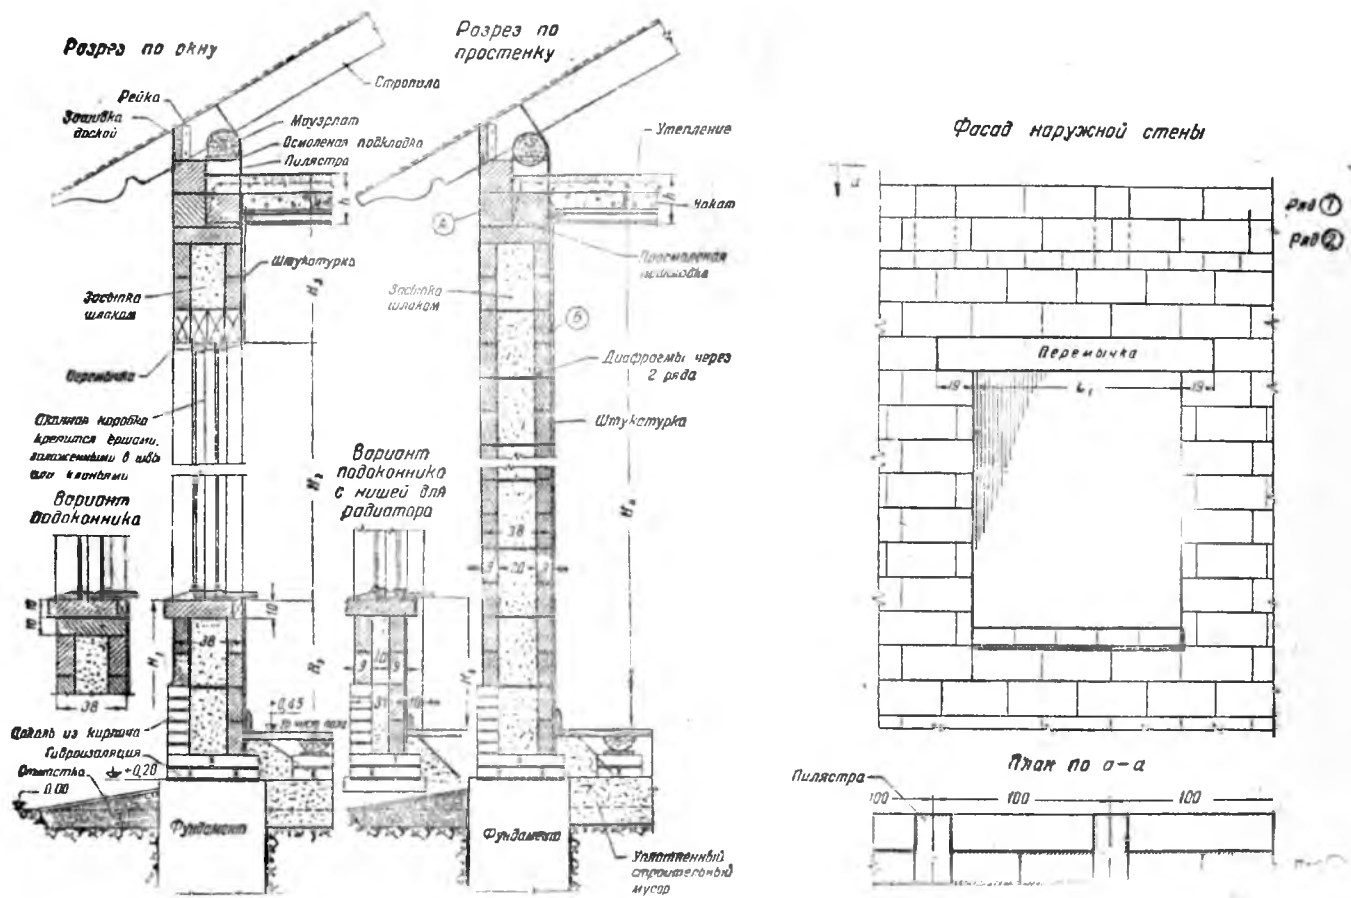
Засыпные стены из утоненных блоков. Разрезы по одноэтажной стене и фасад наружной стены
